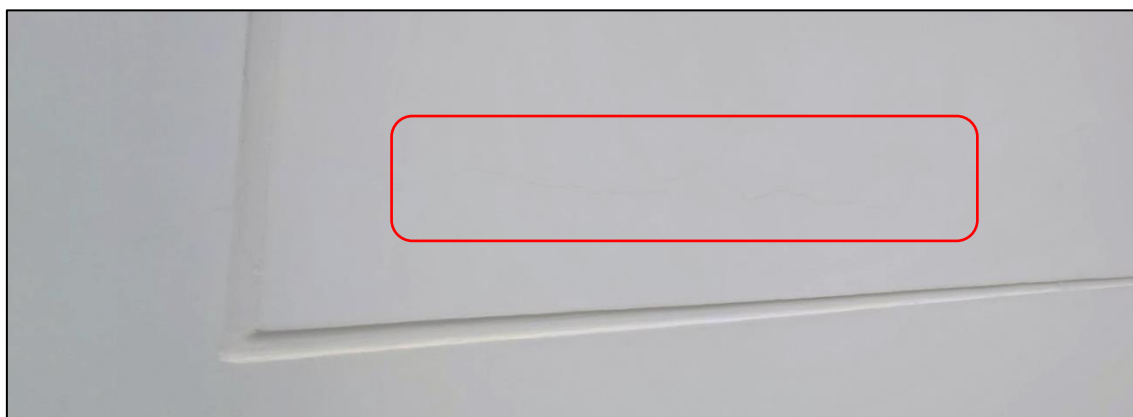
Vista de fisura horizontal en muro de fachada oeste.
